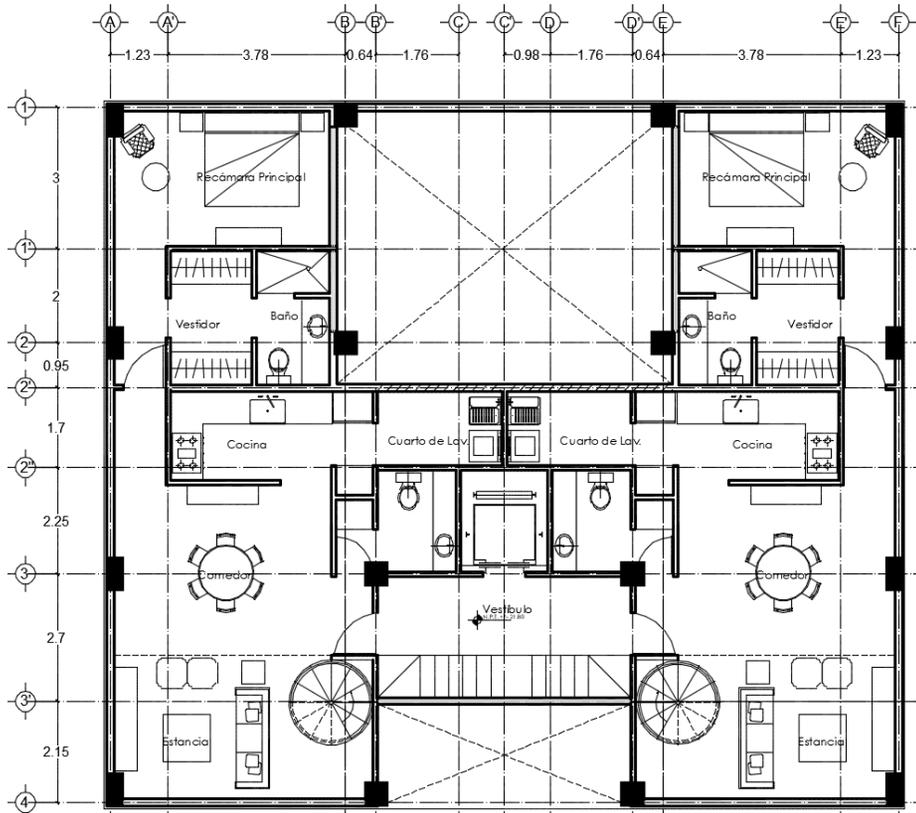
Planta tipo C. Penthouse,- planta baja sexta hipótesis
